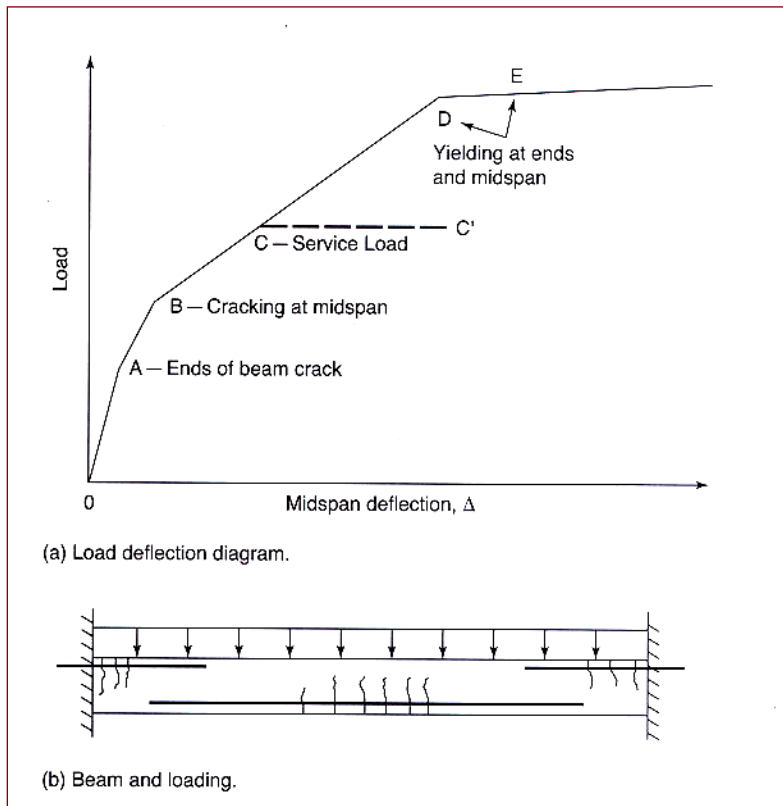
Comportamiento carga-deflexión en una viga de concreto reforzado.
